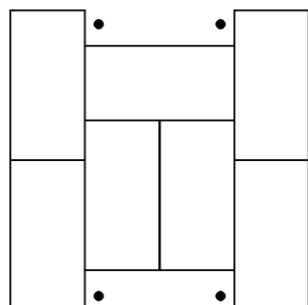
Widok A-A murowanego słupa wzmocnionego zbrojeniem
